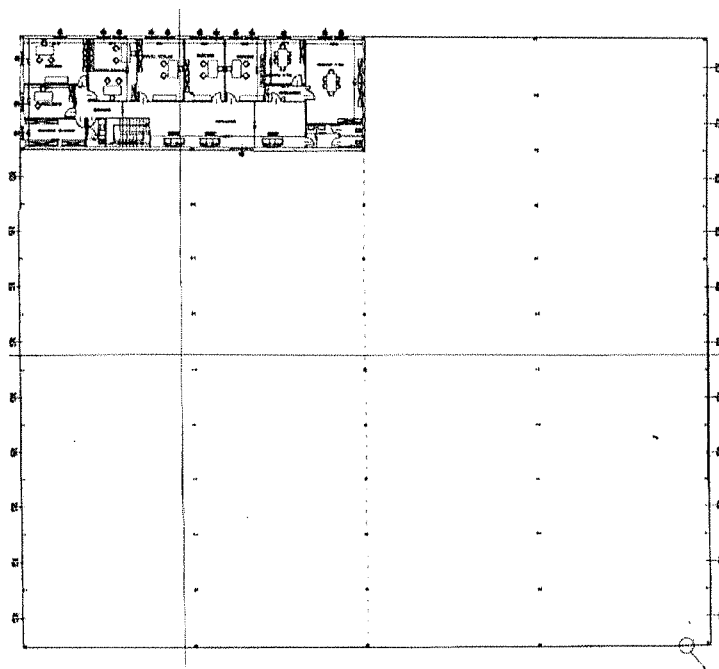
Planimetria di progetto (cfr. all. 7)
